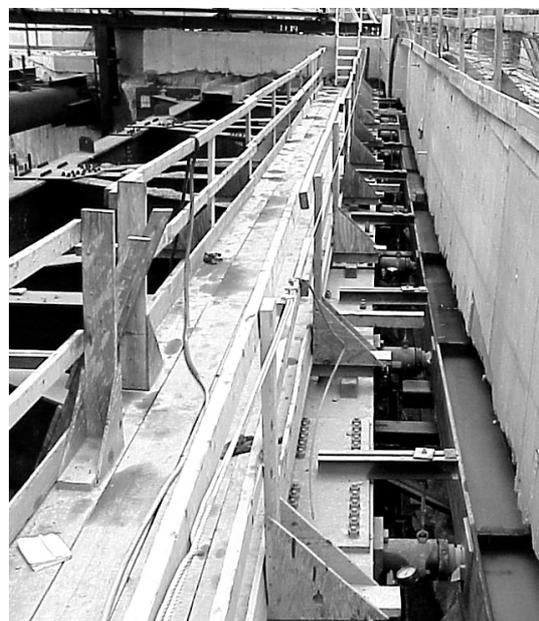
Система по снятию напряжений с верхних стен (горизонтальное давление замороженного грунта контролируется тем, что допускается перемещение подпорной стенки путем использования гидравлических домкратов)
